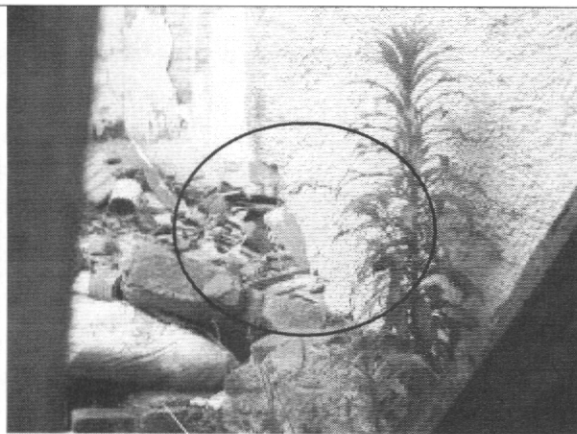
Escombros en interior del inmueble y deterioro de muros interiores
